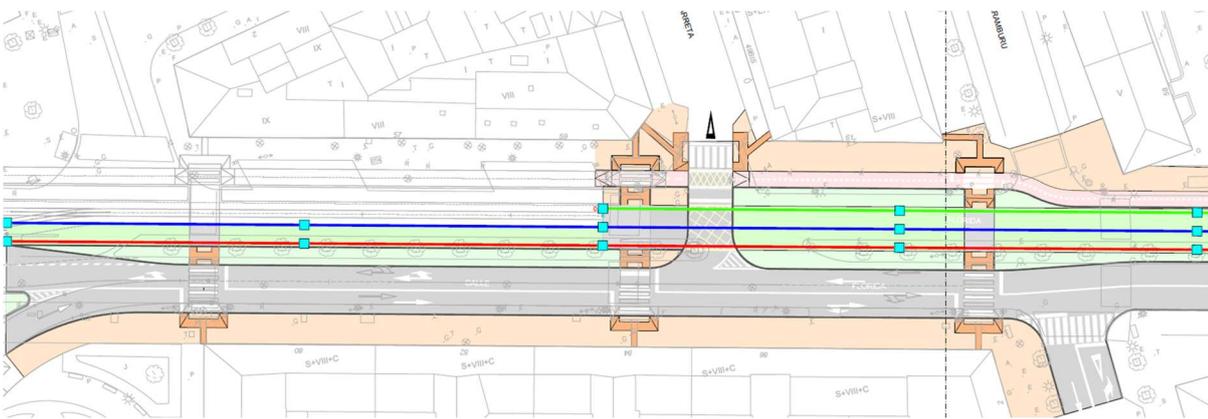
Canalización longitudinal (trazado) – Proyecto Constructivo Ampliación a Salburua
